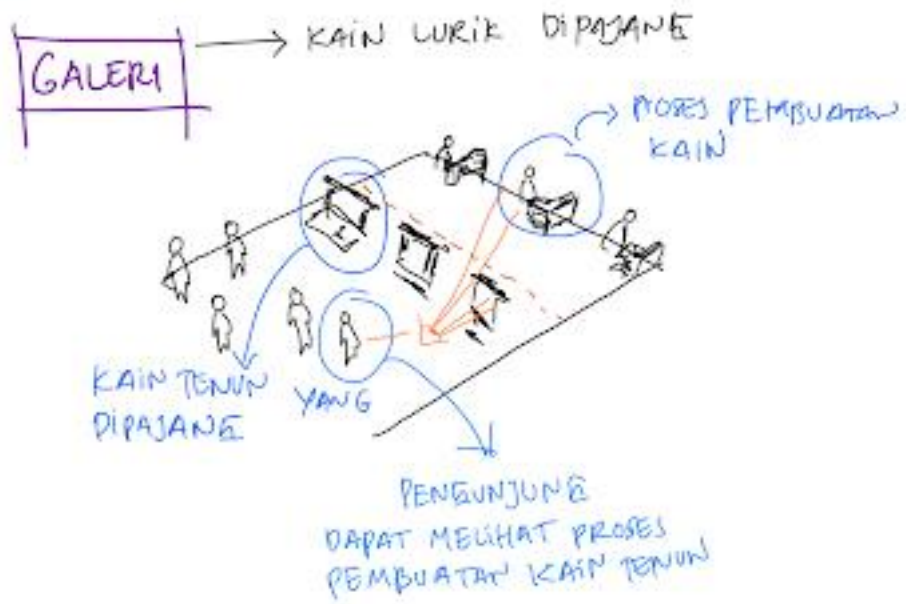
5 Konsep Layout pada Lantai 3
